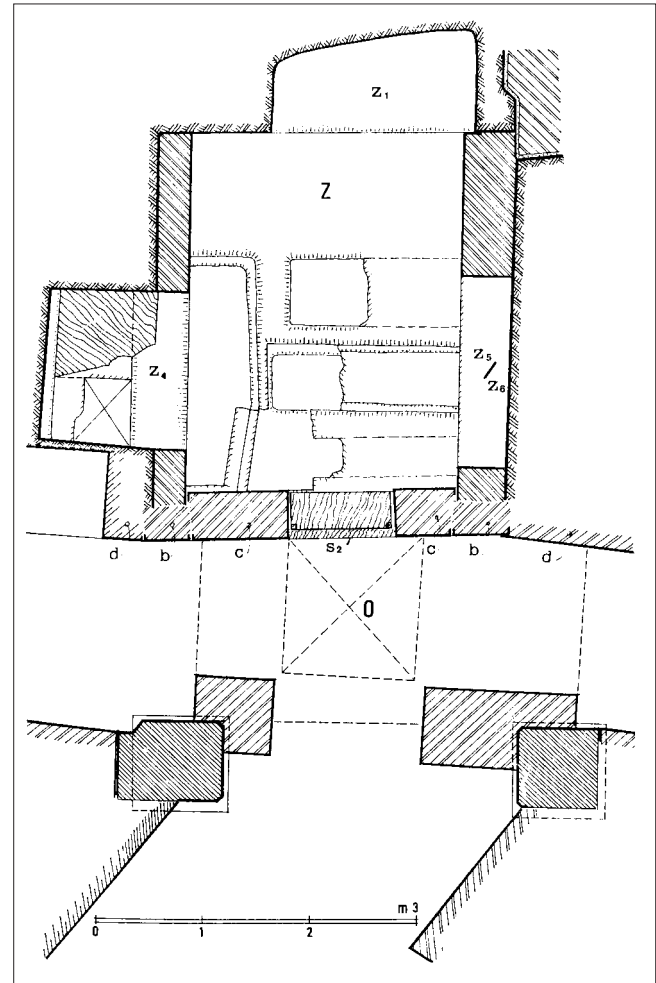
Cubicolo Aox: planimetria (da TOLOTTI 1977).
